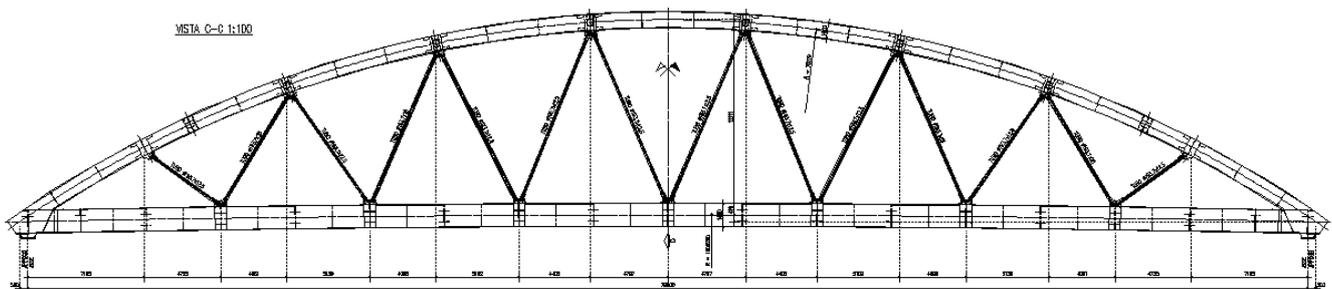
Impalcato-Sezione longitudinale nel piano dell'arco
